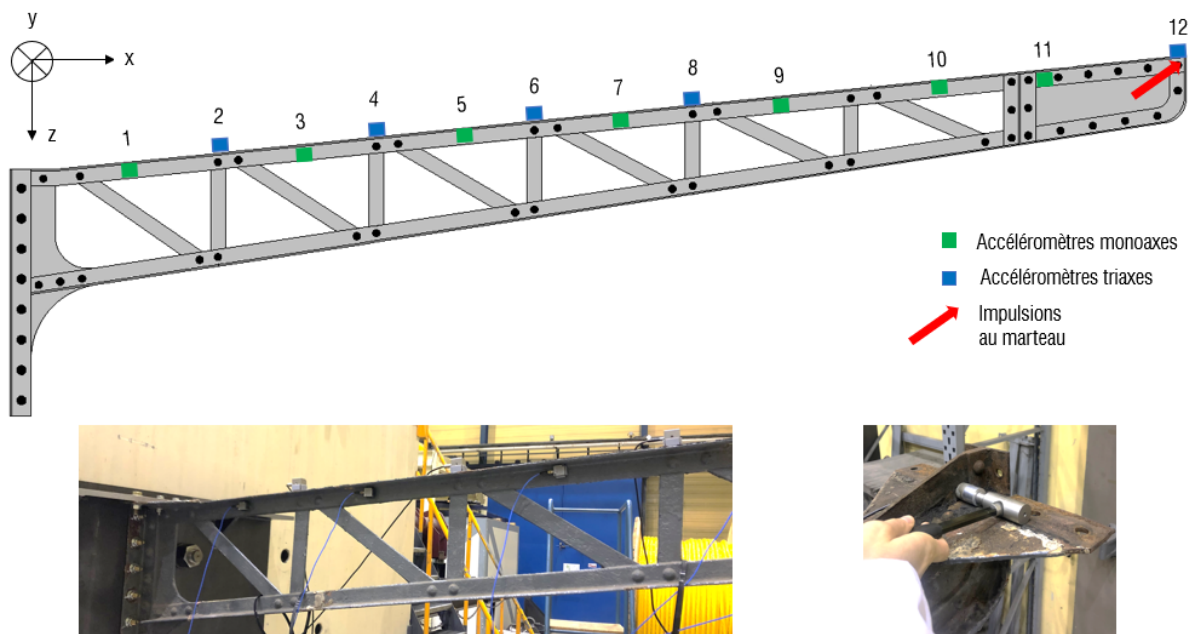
Principe d'un essai avec disposition des accéléromètres en membrure haute de la poutre.
